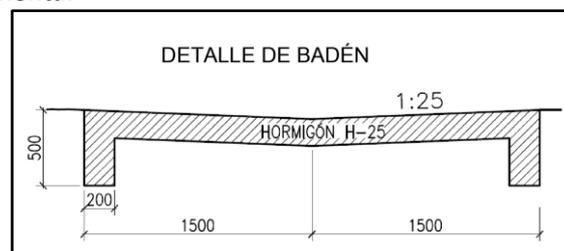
Detalle constructivo de badén de hormigón armado.
